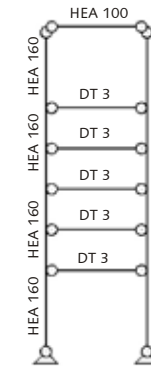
Grundriss Gelenk Ib [m]
